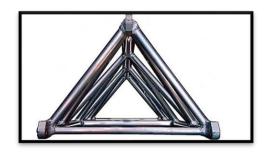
Poutres en treilles triangulaire. Source : PDF Leçon 5 construction ossature
